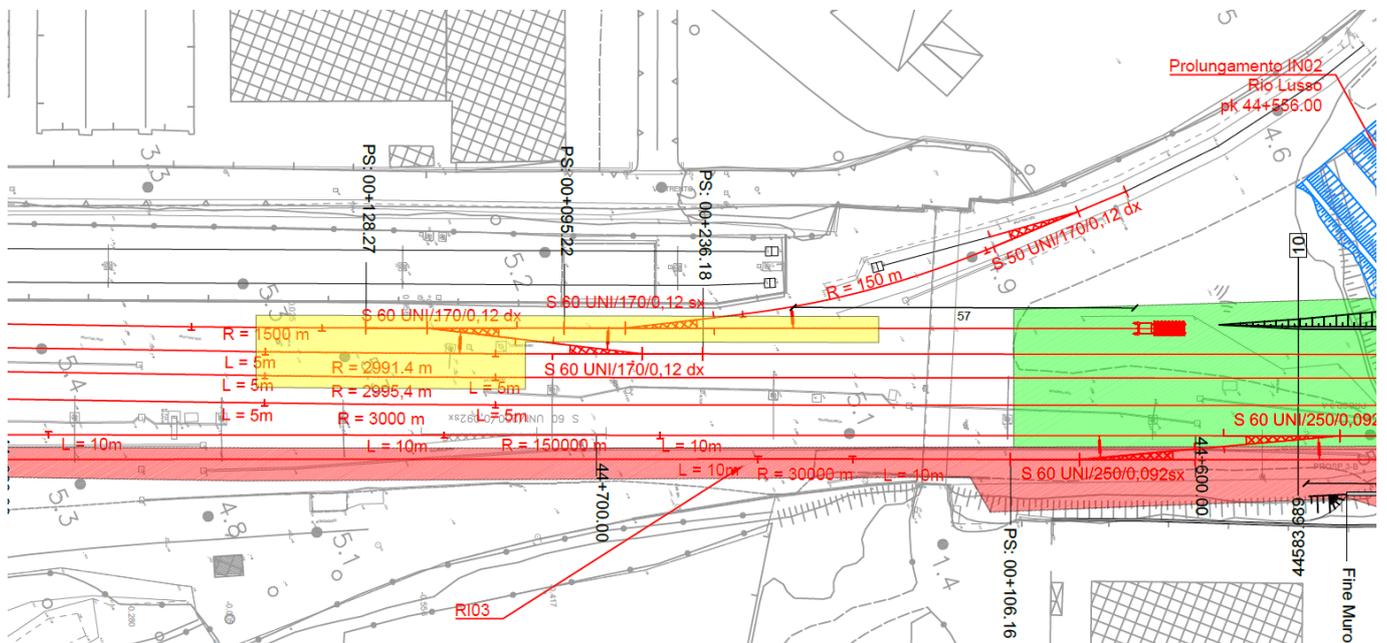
RI02 – Planimetria tratto lato Savona
